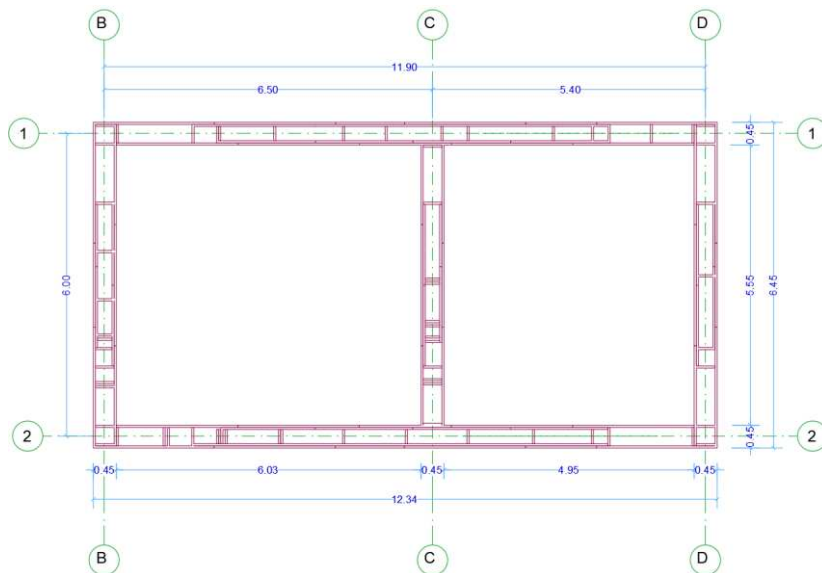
Vista en planta y configuración estructural de los pórticos.
